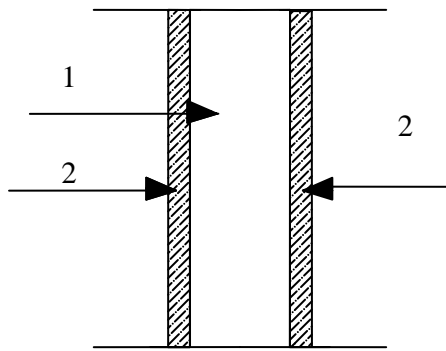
Coupe transversale du mur intérieur (brique de 10 cm d'épaisseur)
